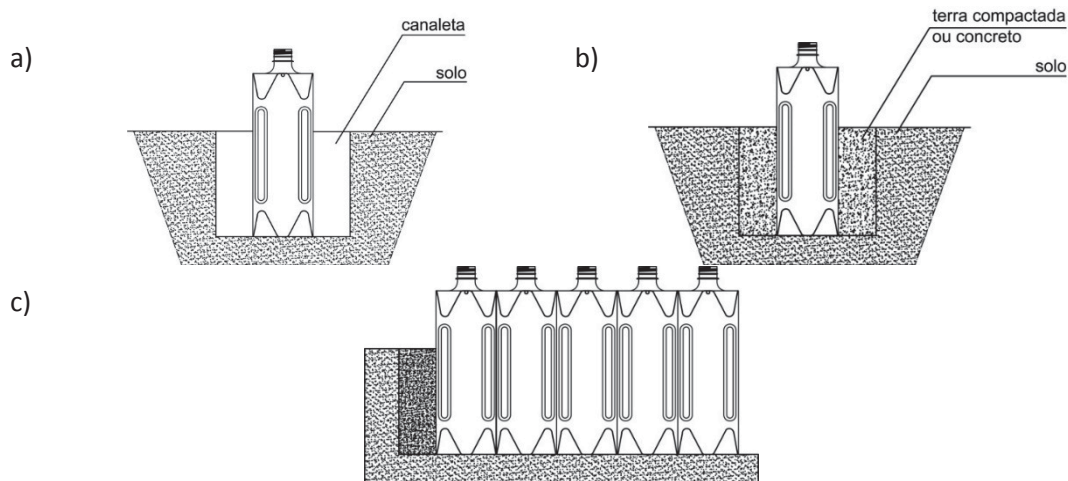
a) Vista Transversal da fundação b) Vista Transversal da fundação completada com a Terra compactada ou o concreto c) Vista Longitudinal da fundação
